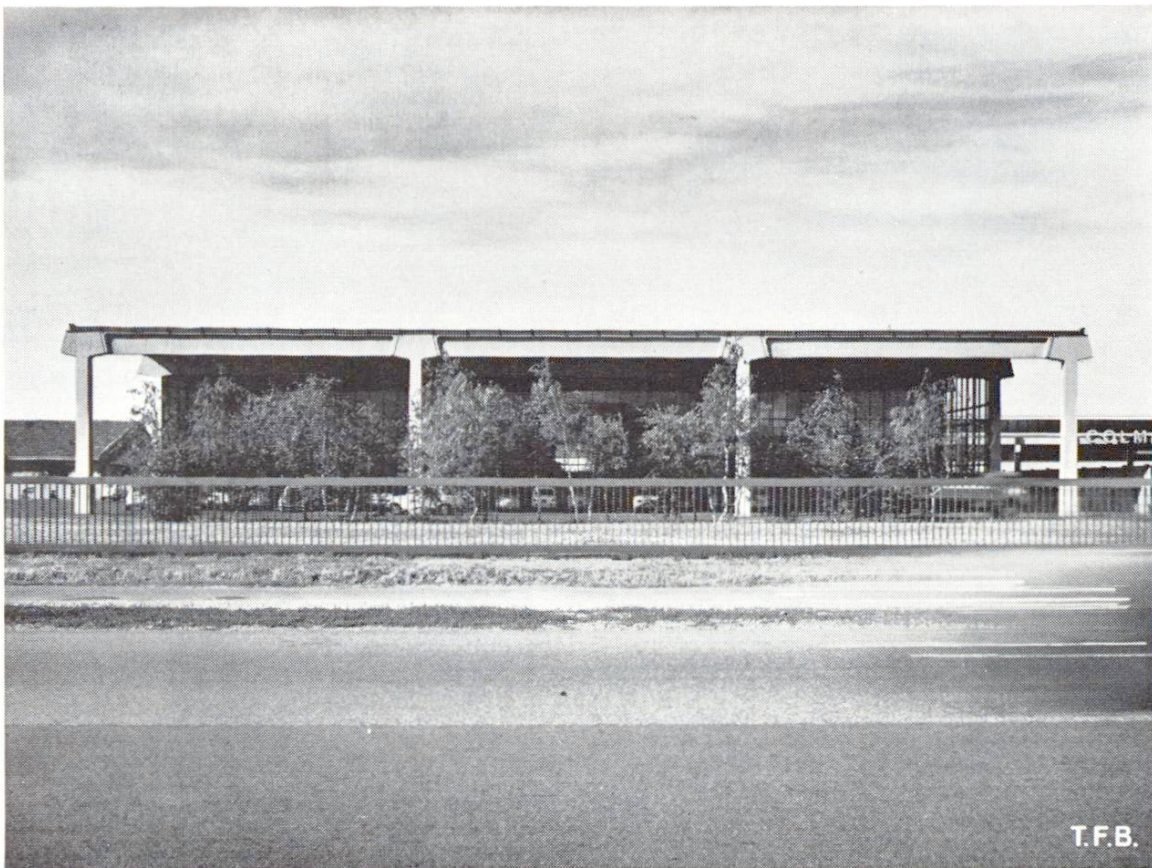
Schräge Fassadenansicht, bei welcher die schöne Formgebung der Pfeiler und Balken zum Ausdruck kommt.
